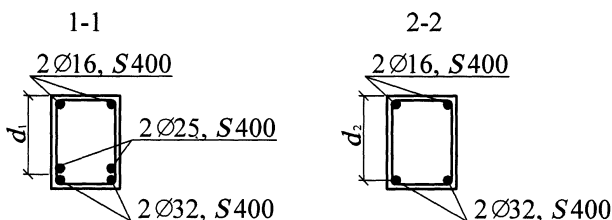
К определению мест обрыва продольной арматуры в ригеле
